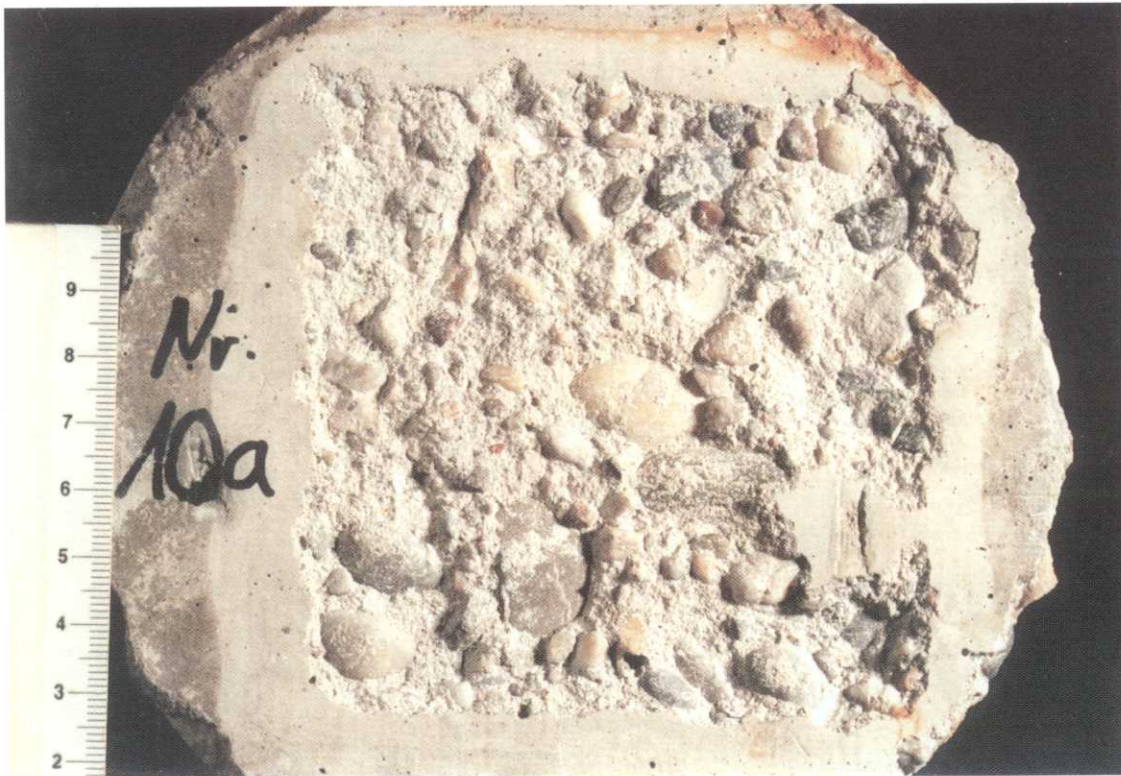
Untersuchungsabschnitt II Frost-Tausalzbeanspruchter Ausschnitt einer ohne ZEMDRAIN-Schalungsbahn vertikal hergestellten Betonoberfläche (14 Tage nachbehandelt) 17 Frost-Tauwechsel.
